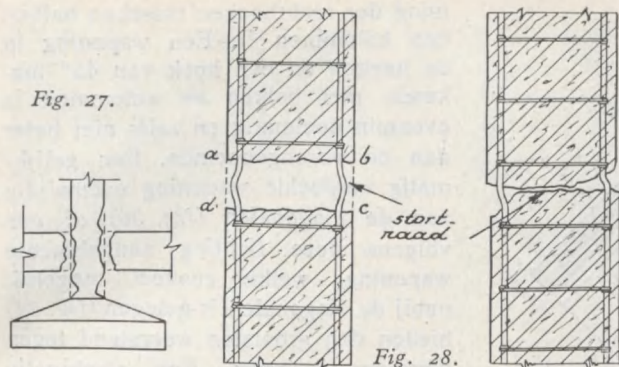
Breuk tusschen gewapend beton kolommen en balken even boven de fundeering.
